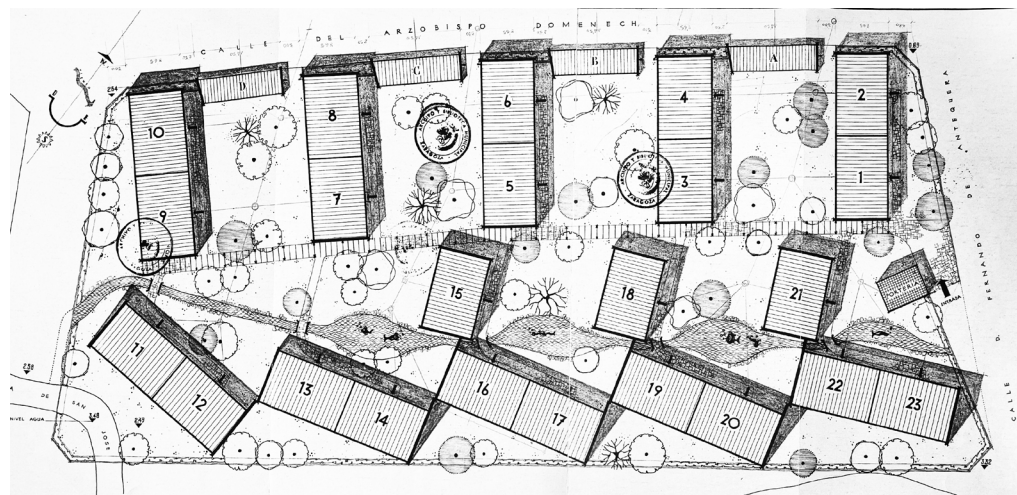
, 83 y 84. Planta de techos, Viviendas Tipo y Alzados de bloque general para viviendas protegidas del Grupo Salduba. 1958
